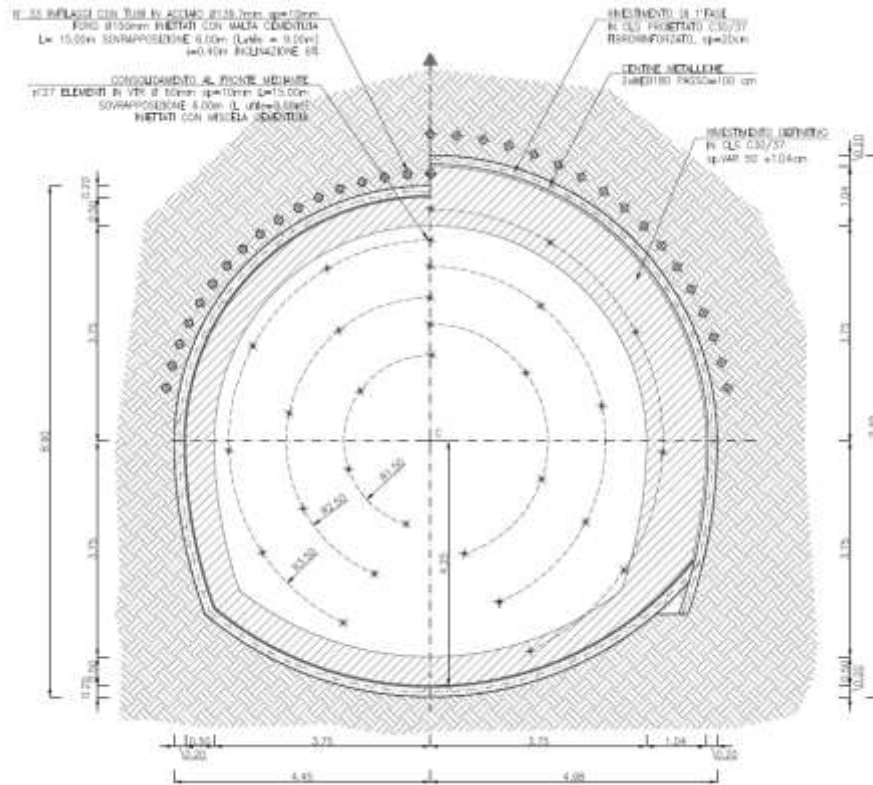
Sezione tipo Sf-imb: geometria del cavo e interventi di sostegno, sezione trasversale
